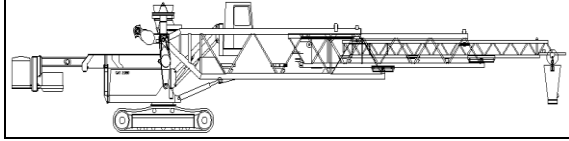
Detalle del *Crawler Placer* de la compañía ROTEC, utilizado en la presa del PH PIRRÍS para la distribución de RCC
